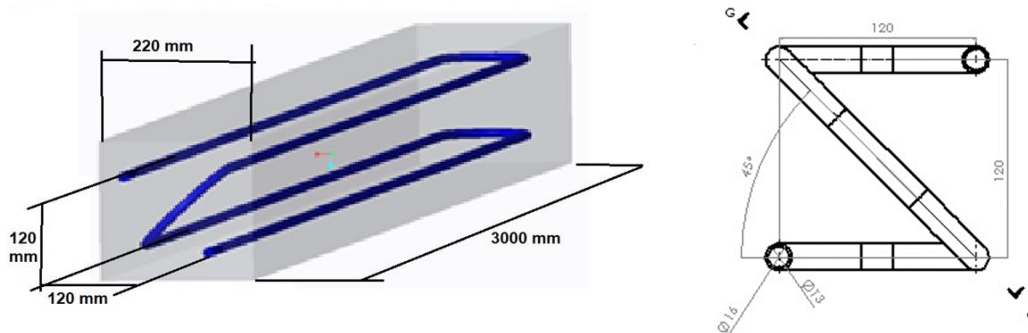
Schema di elementi di accumulo termico in calcestruzzo.
